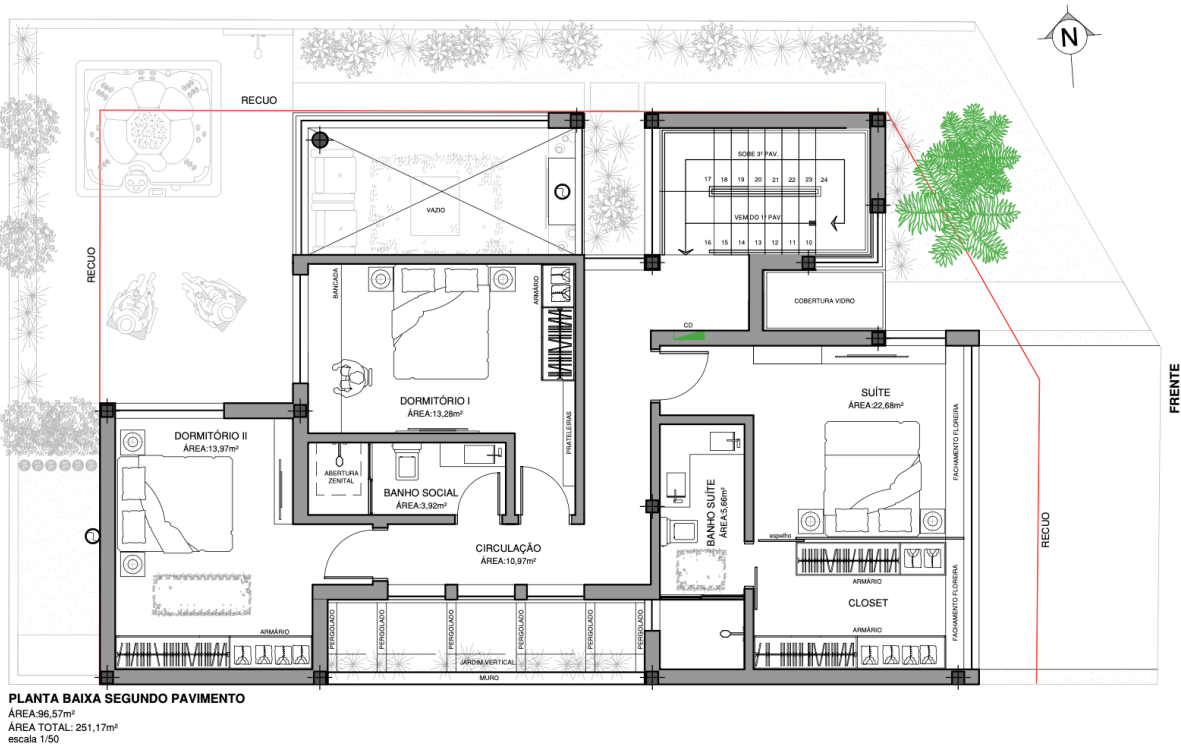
Planta baixa segundo pavimento. (Fonte: Projeto Arquitetônico)
